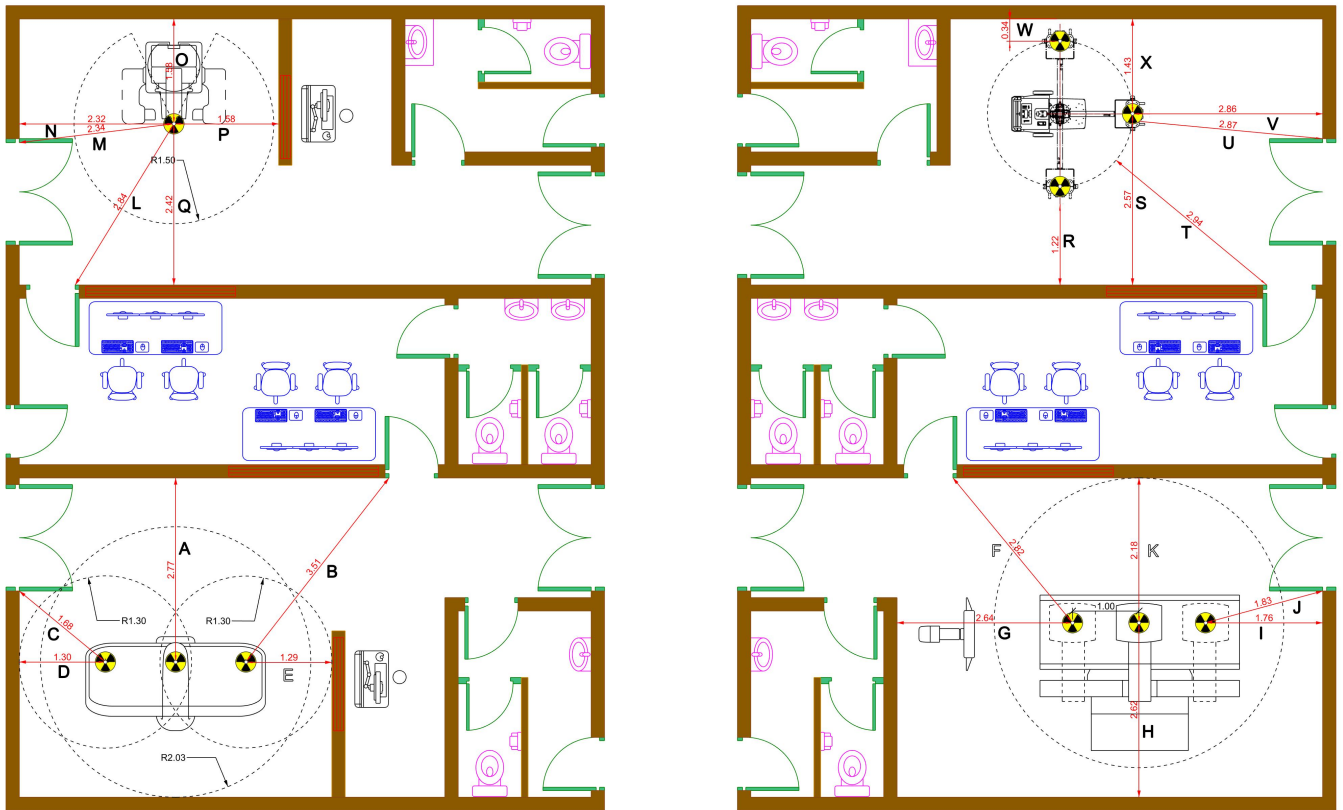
Plano de dimensiones escala 1:100 para cálculo de blindaje, autoría propia.
